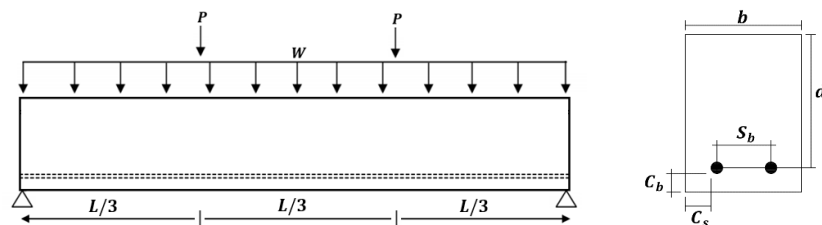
Carregamento e detalhamento transversal das vigas de Gilbert e Nejadi (2004).
